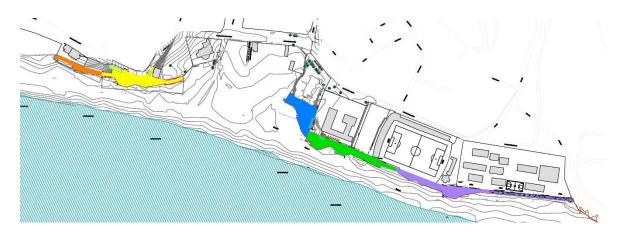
Plano de conjunto, identificación de las 6 zonas
